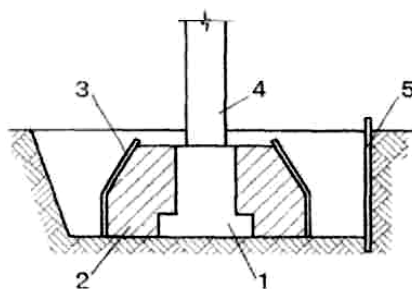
Схема підсилення фундаментів збільшенням опорної площі;
